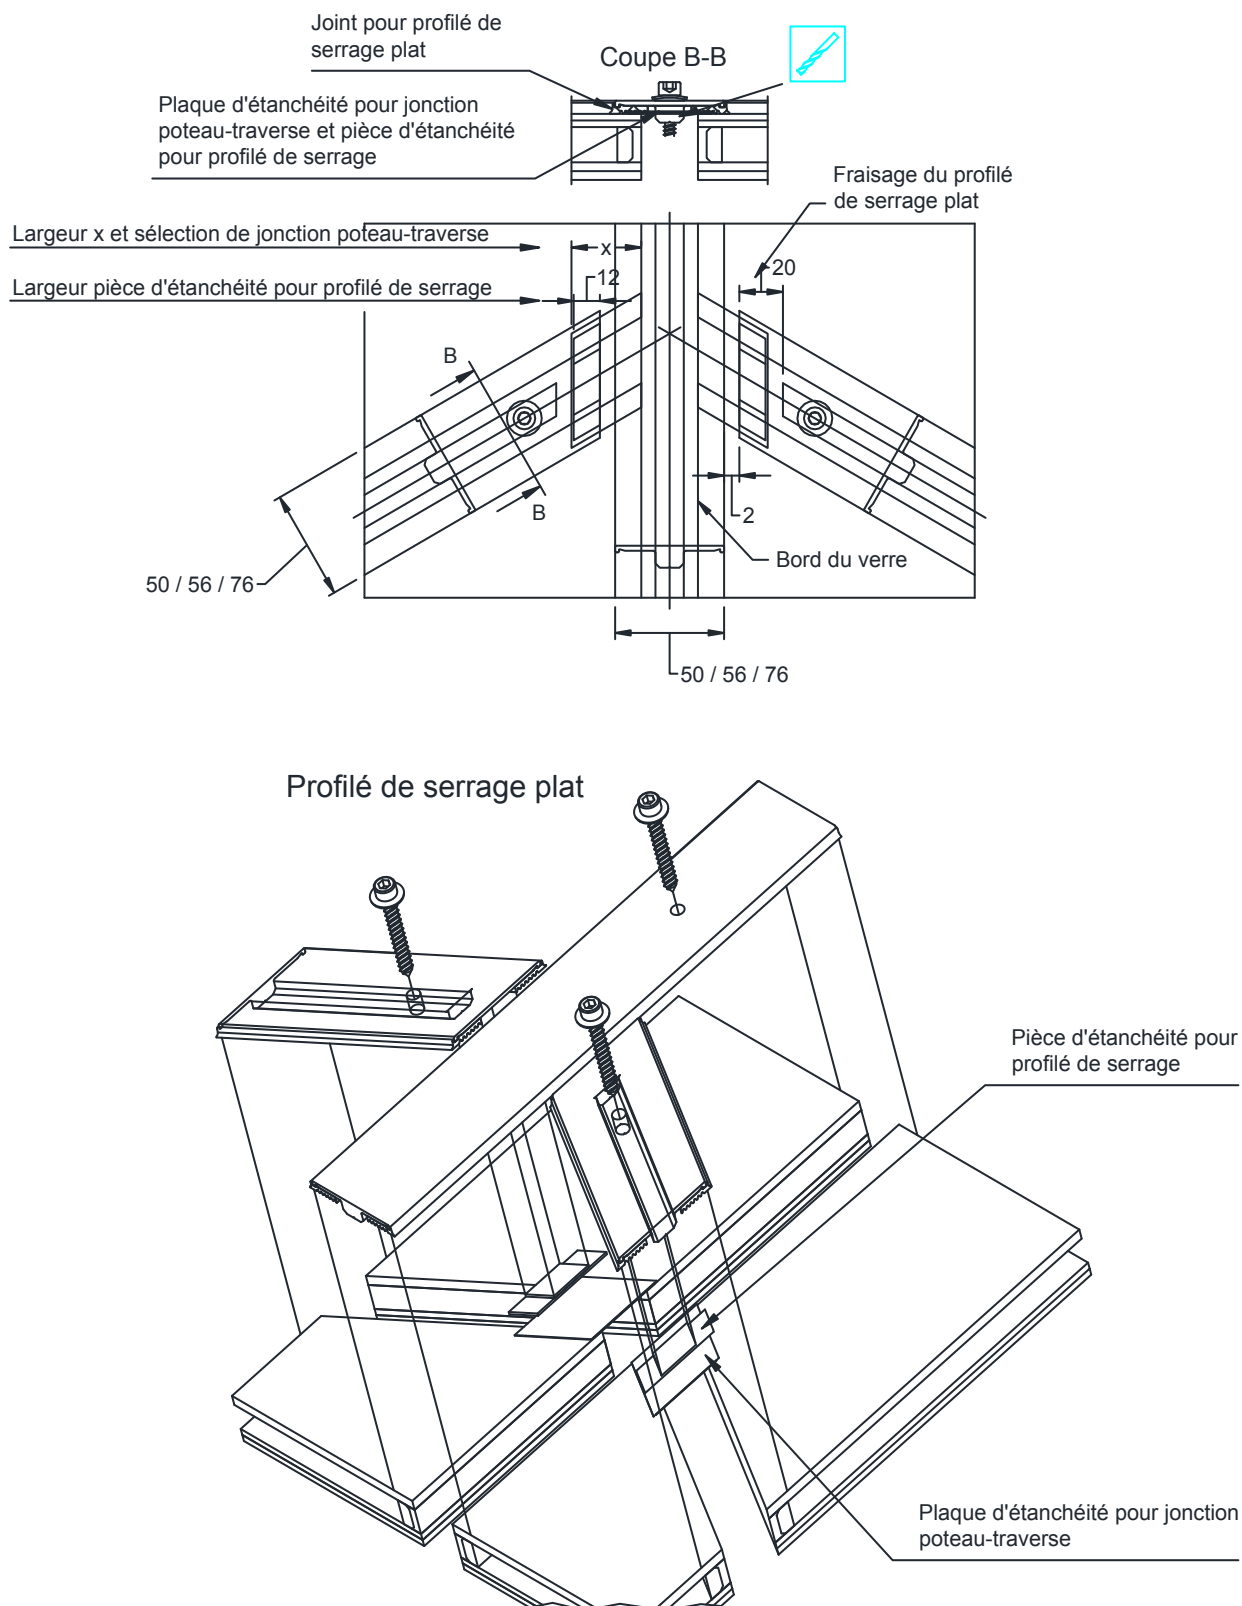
Plaques d'étanchéité et pièces d'étanchéité pour profilé de serrage pour raccordement en biais : serreur plat de 3 mm
